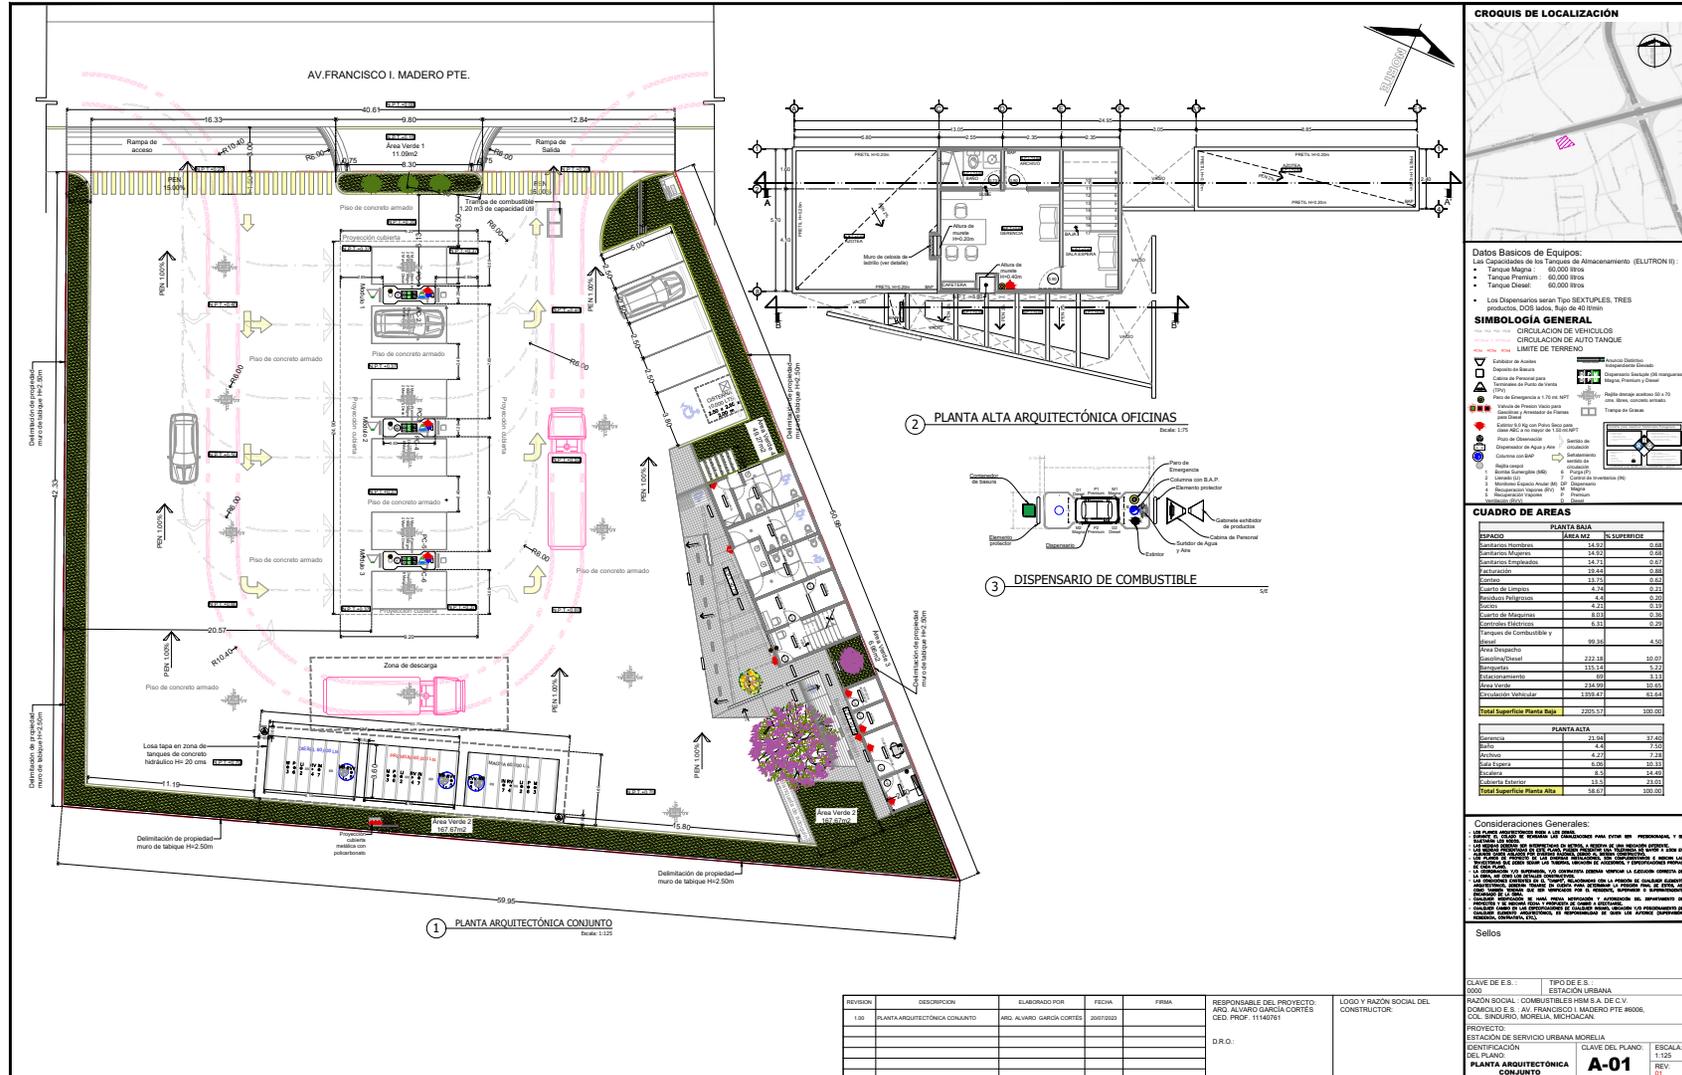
PLANTA ARQUITECTONICA CONJUNTO.
